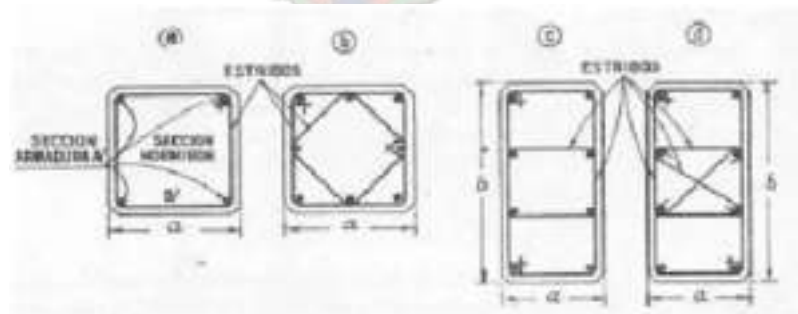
Diferentes tipos de columnas de Hormigón Armado
